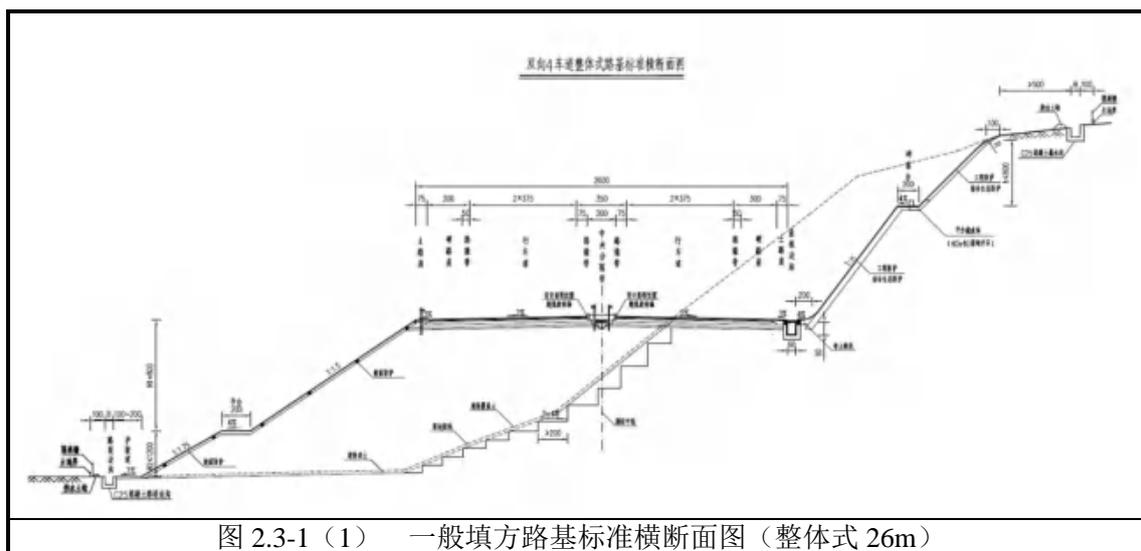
(1) 一般填方路基标准横断面图 (整体式 26m)
